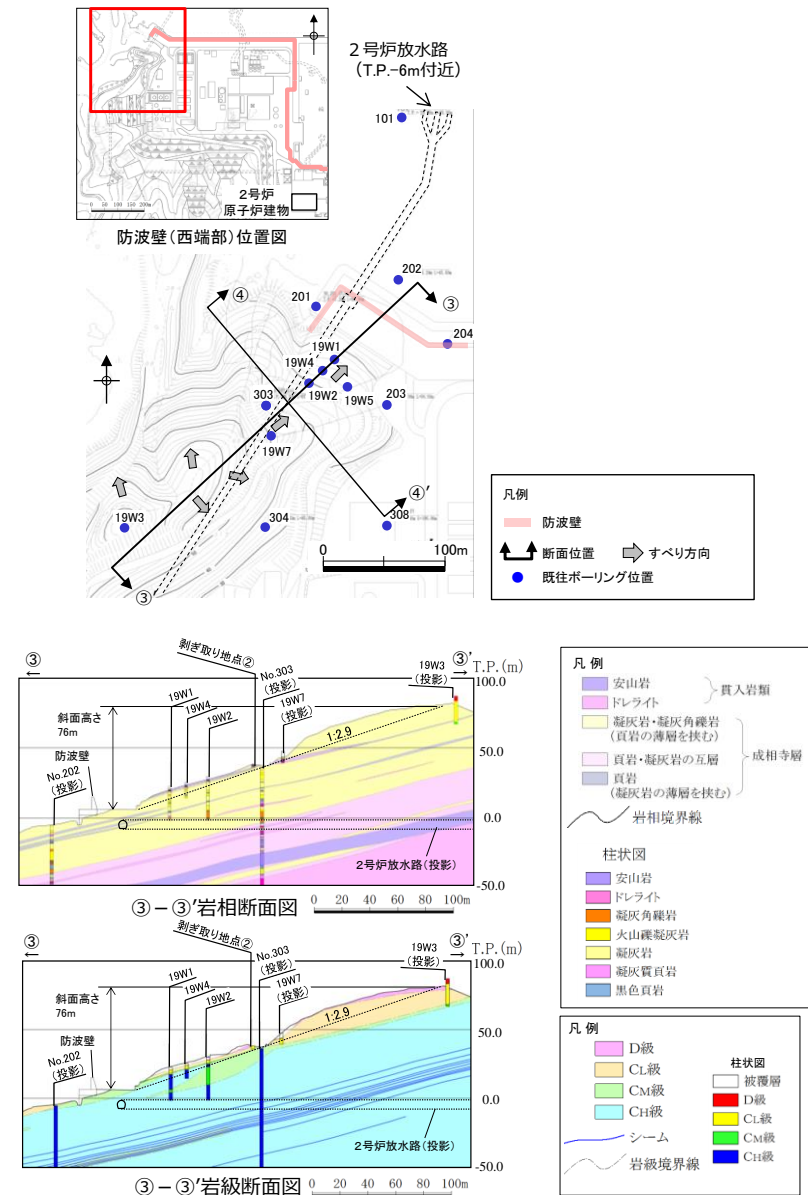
(1) 防波壁(西端部) 地質断面図・岩級断面図
